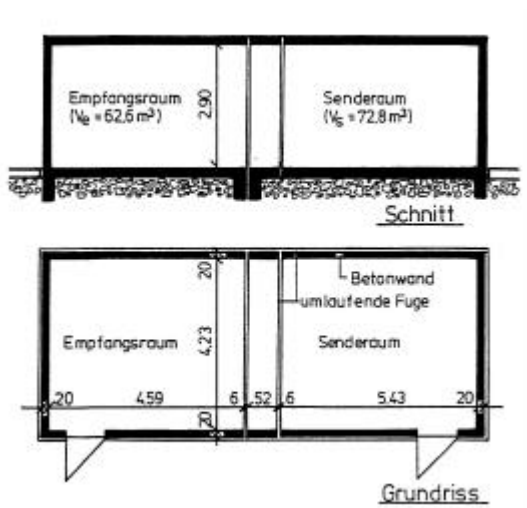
Grundriss und Schnitt des Prüfraums
